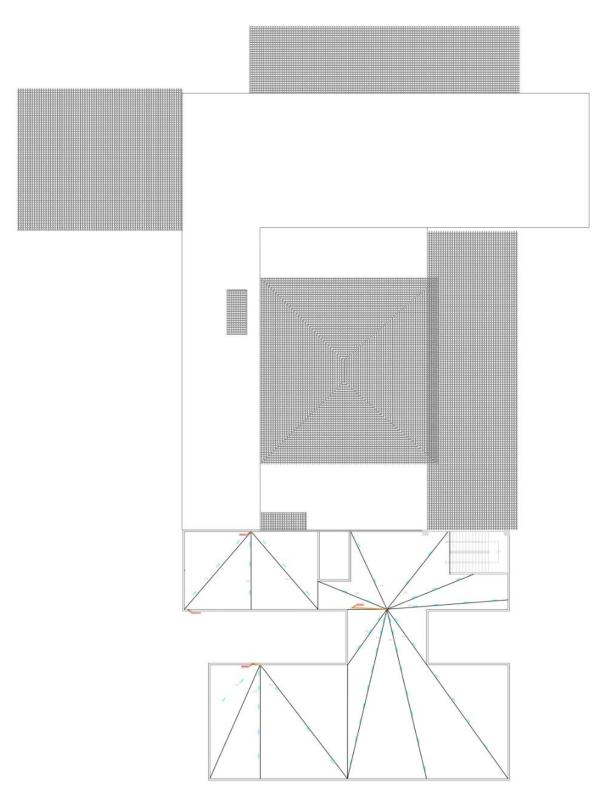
Desagüe Planta de Techos – Drenaje Pluvial.
